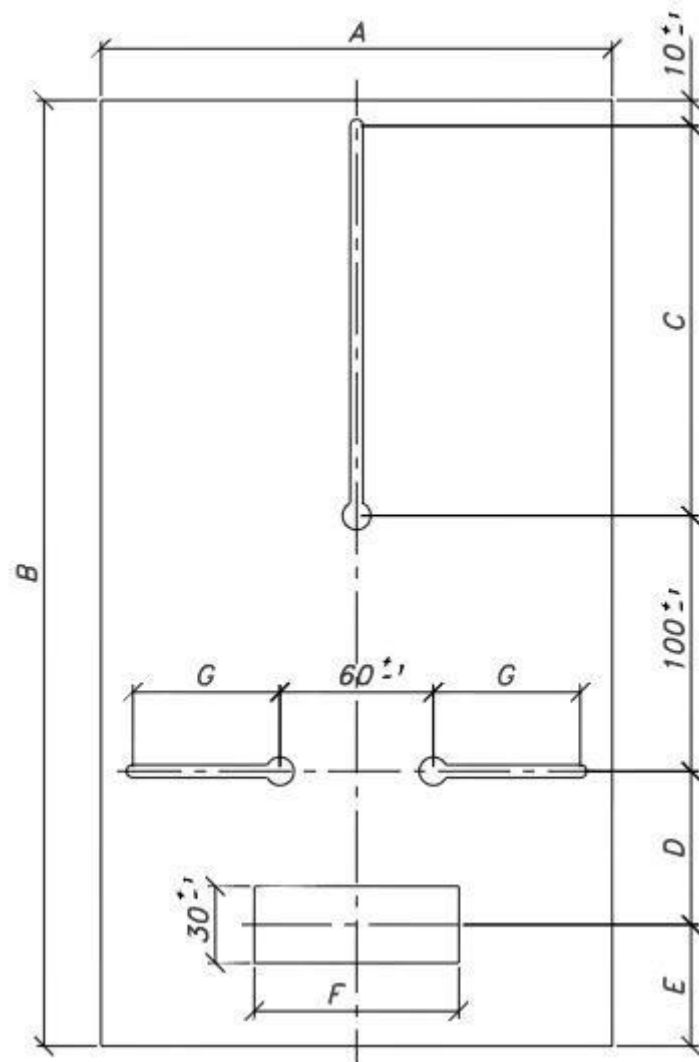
Panel de montaje de contadores. Dimensiones en mm
